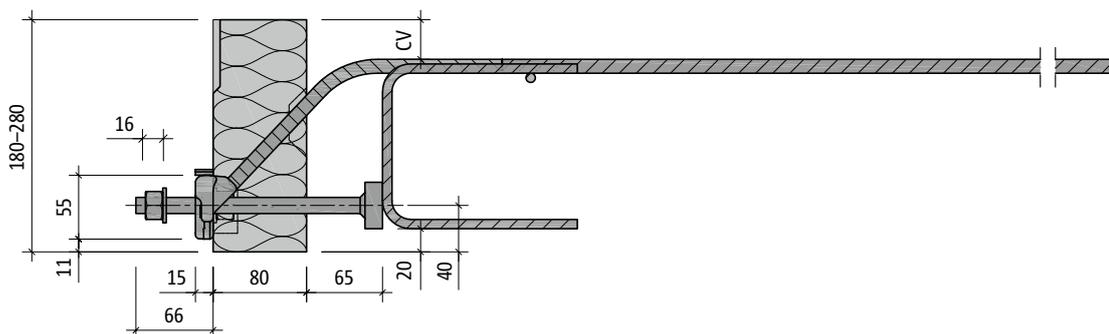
Schöck Isokorb® T tipo SQ-V3: Sección del producto
